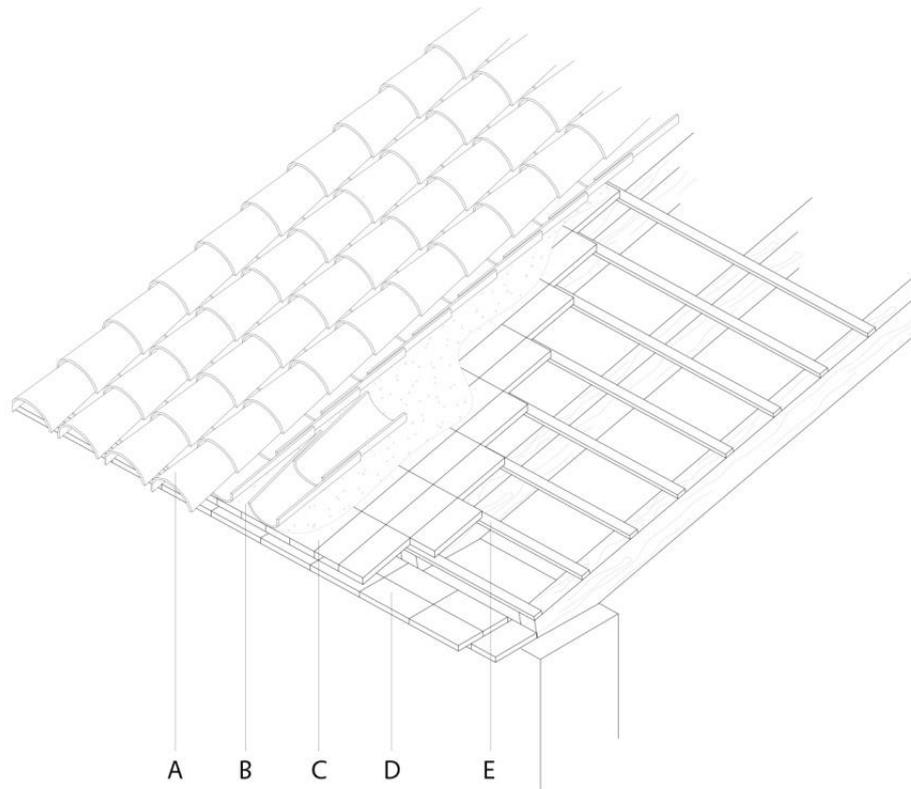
Detalle constructivo de cubierta inclinada con entabicao de rasilla. A: Teja cerámica, B: Mortero de asiento, C: Entabicao de rasilla, D: Alero de rasilla, E: Rastreles de madera.
